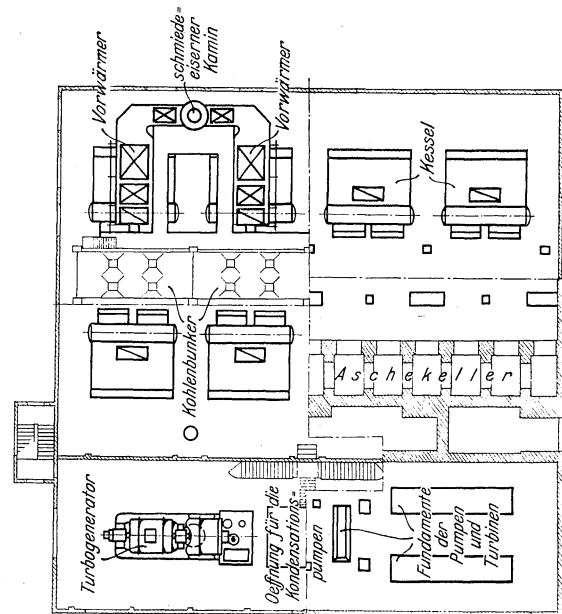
Grundriß des Maschinen- und Kesselhauses.
